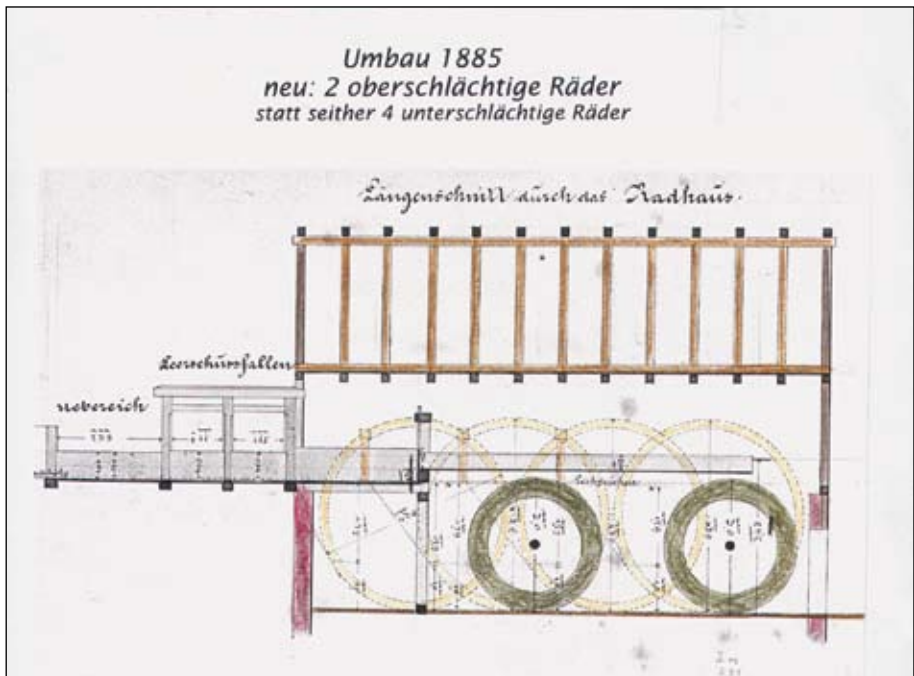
Umbau 1885 und Ausrüstung mit zwei ober-schlächtigen Wasserrädern.
